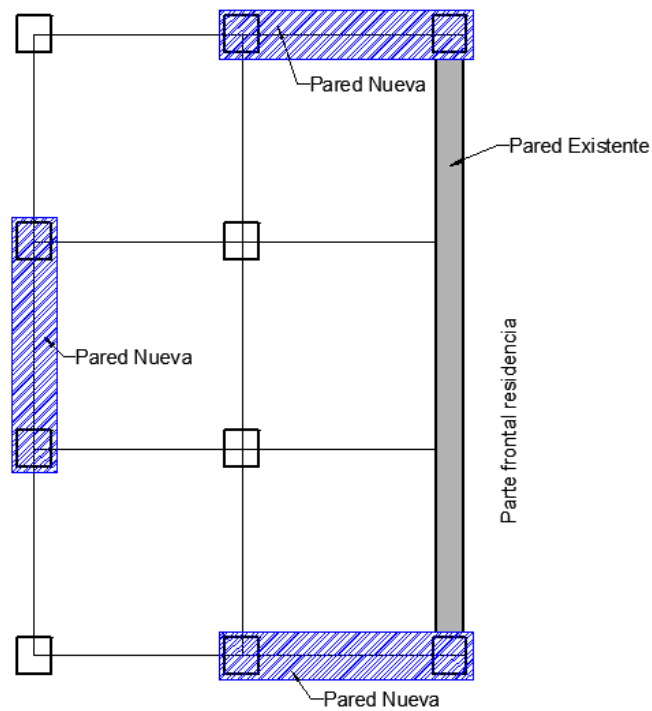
Vista en Planta de Casa en Zancos con Posible Localización de las Paredes Nuevas
